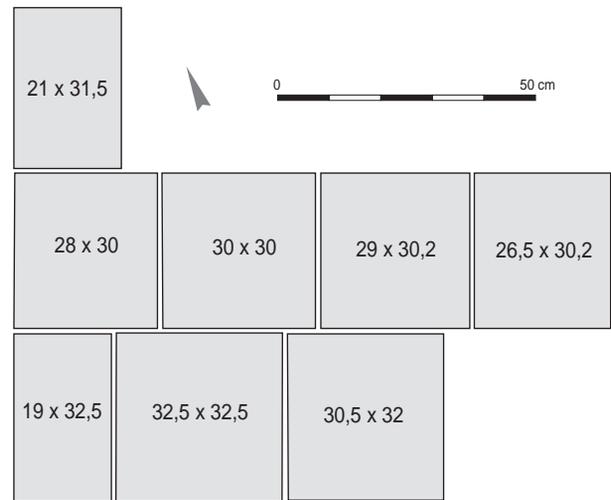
Cour du Grand Commun de Versailles : disposition des dalles du sol 182 (M. Viré / Inrap).
